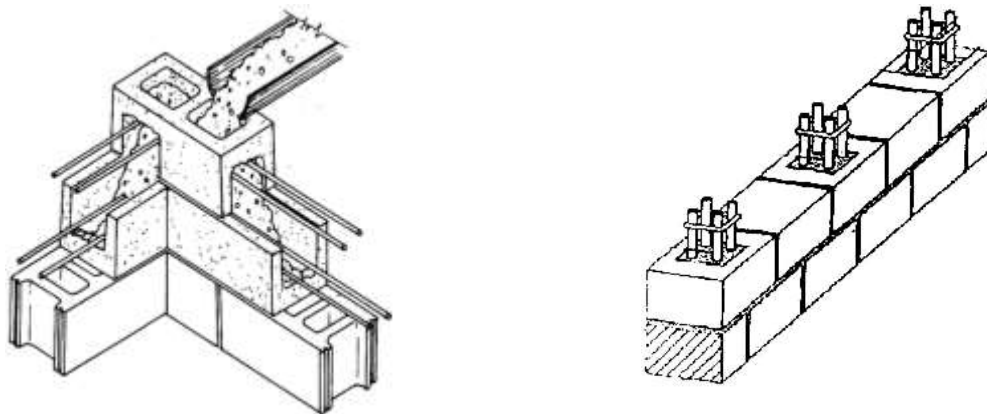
Горизонтальное и вертикальное армирование комплексных конструкций
